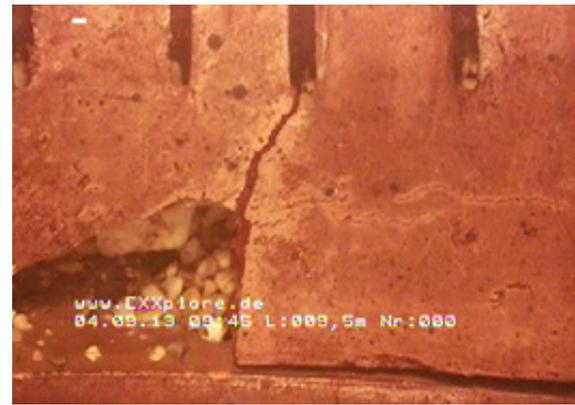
Loch im Steinzeugfilter mit sichtbarer Kiesschüttung
